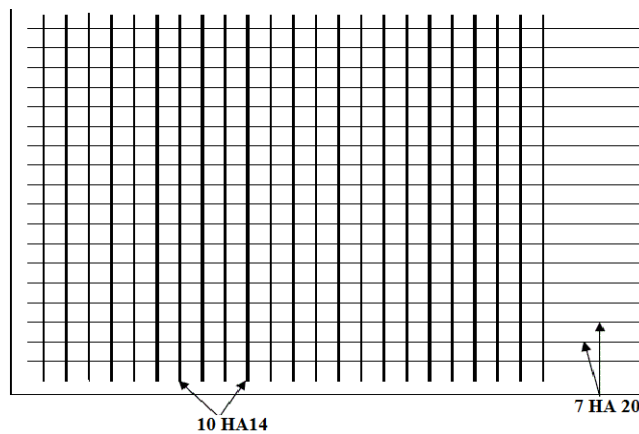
Ferrailage de la semelle (nappe supérieur).
